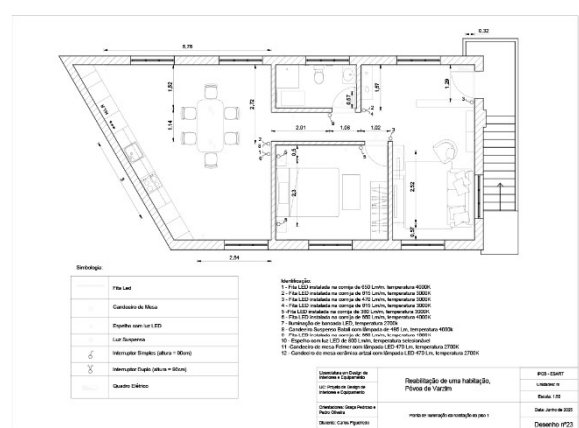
Planta de Iluminação Habitação Piso 1. Fonte: Autor.
